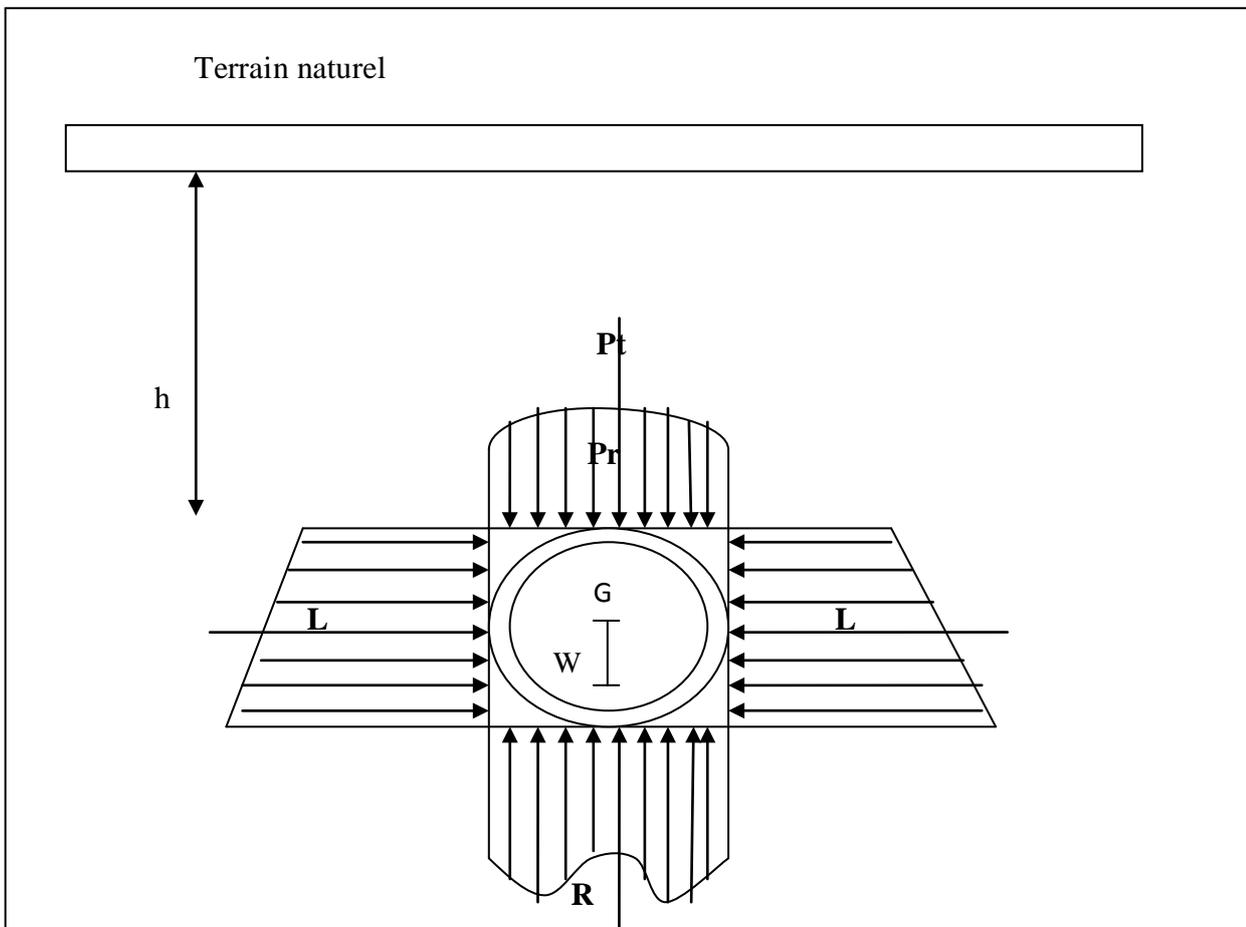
Epure des contraintes extérieures s'exerçant sur une conduite enterrée.
